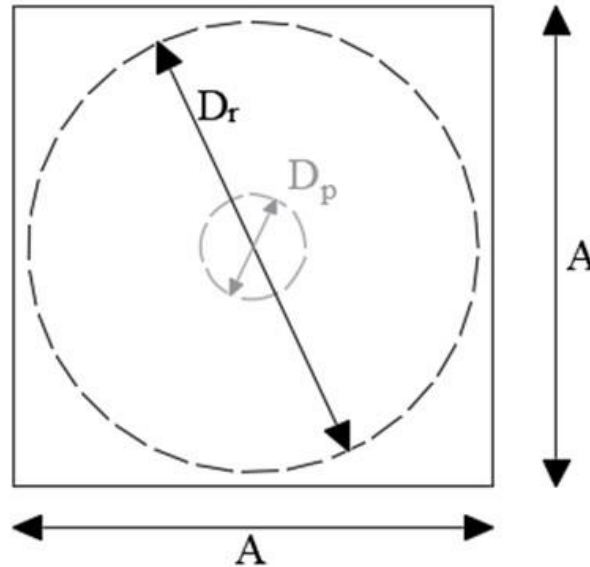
Dimensiones de un aislador visto en planta (propia)
